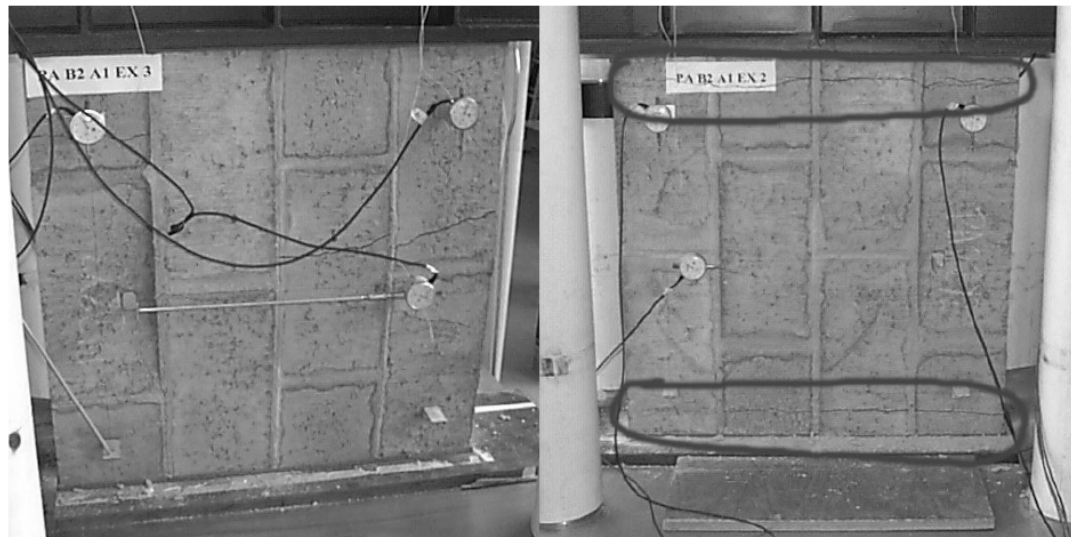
Detalhe da fissuração ao longo dos septos laterais da parede
